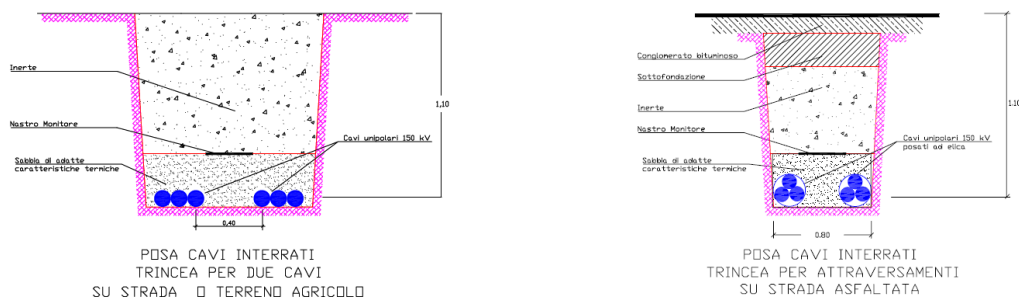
Schema sezione di trincea cavi terrestri.
